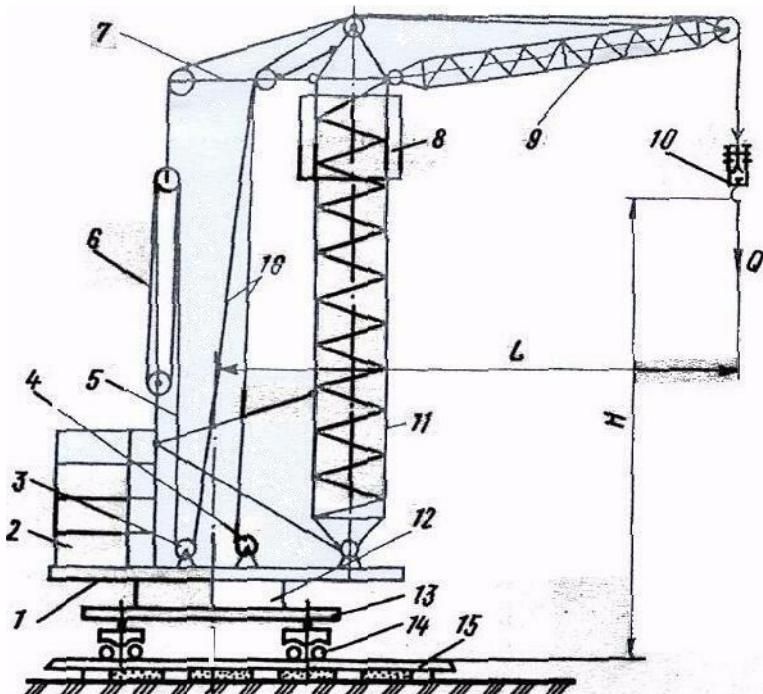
Схема баштового крана з поворотною баштою:
